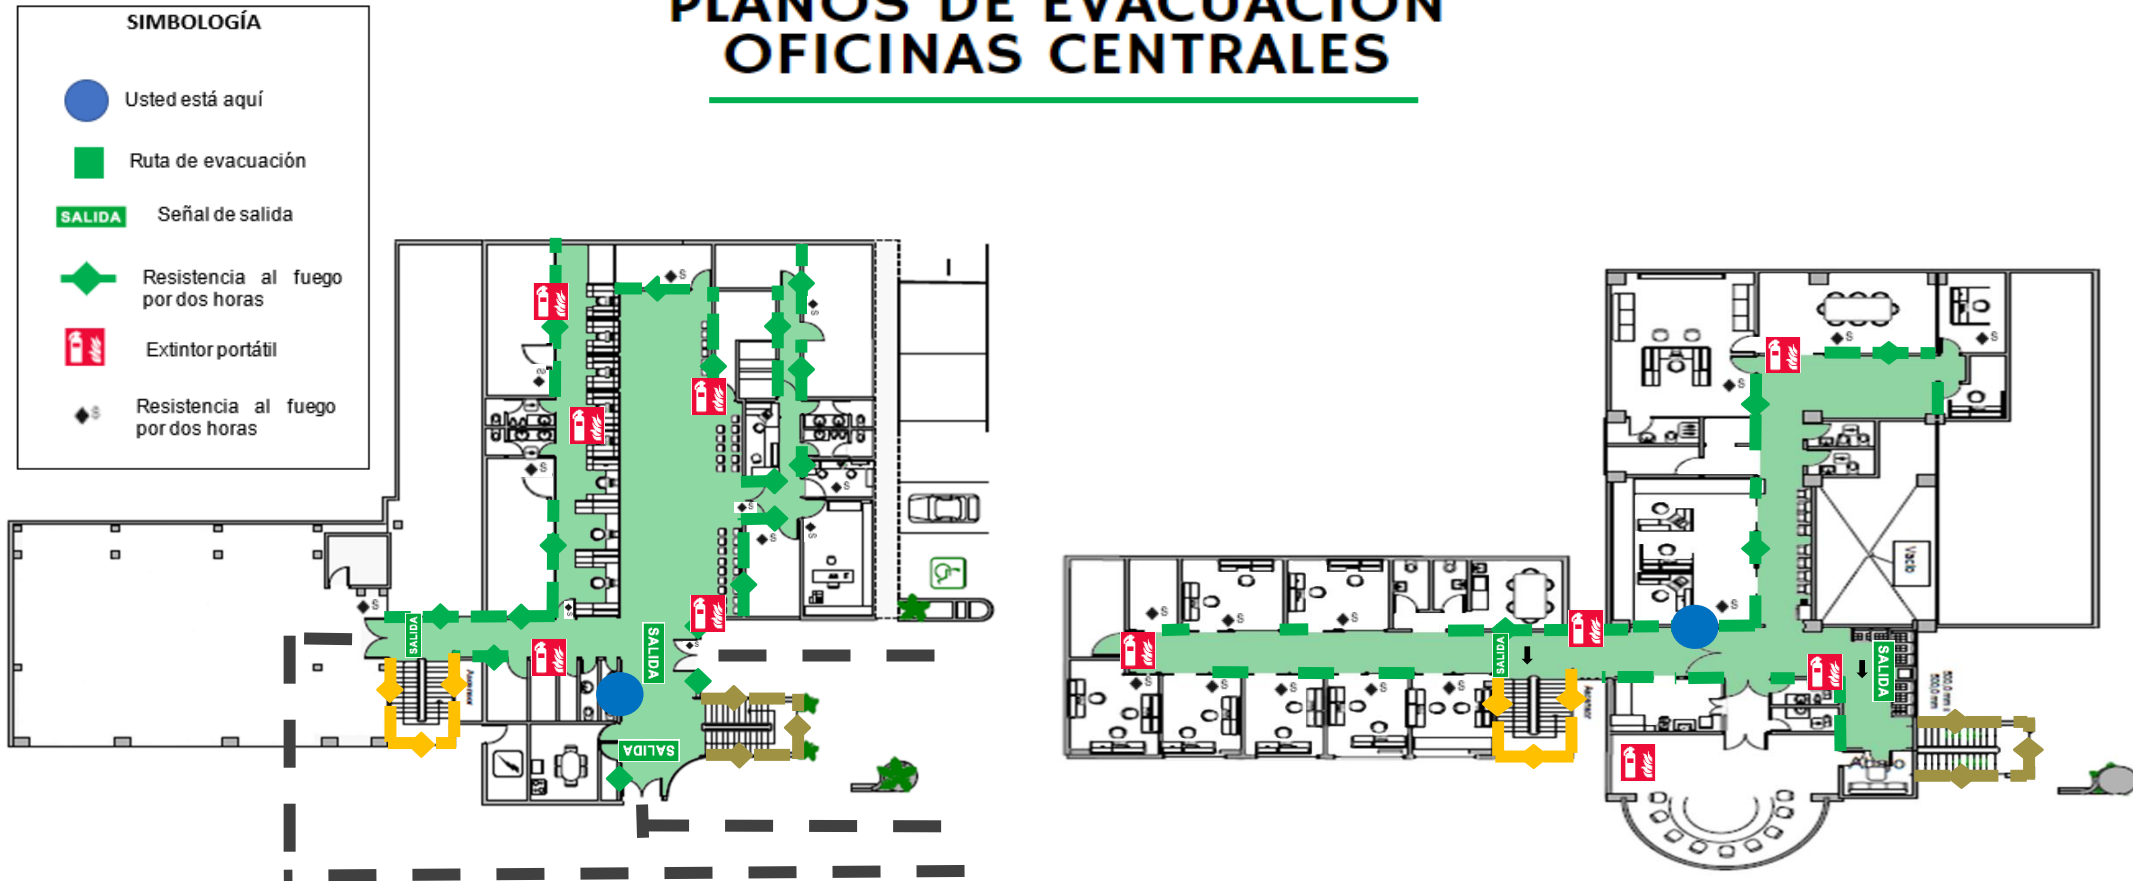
Planos de evacuación primera y segunda planta Oficinas Centrales, respectivamente
